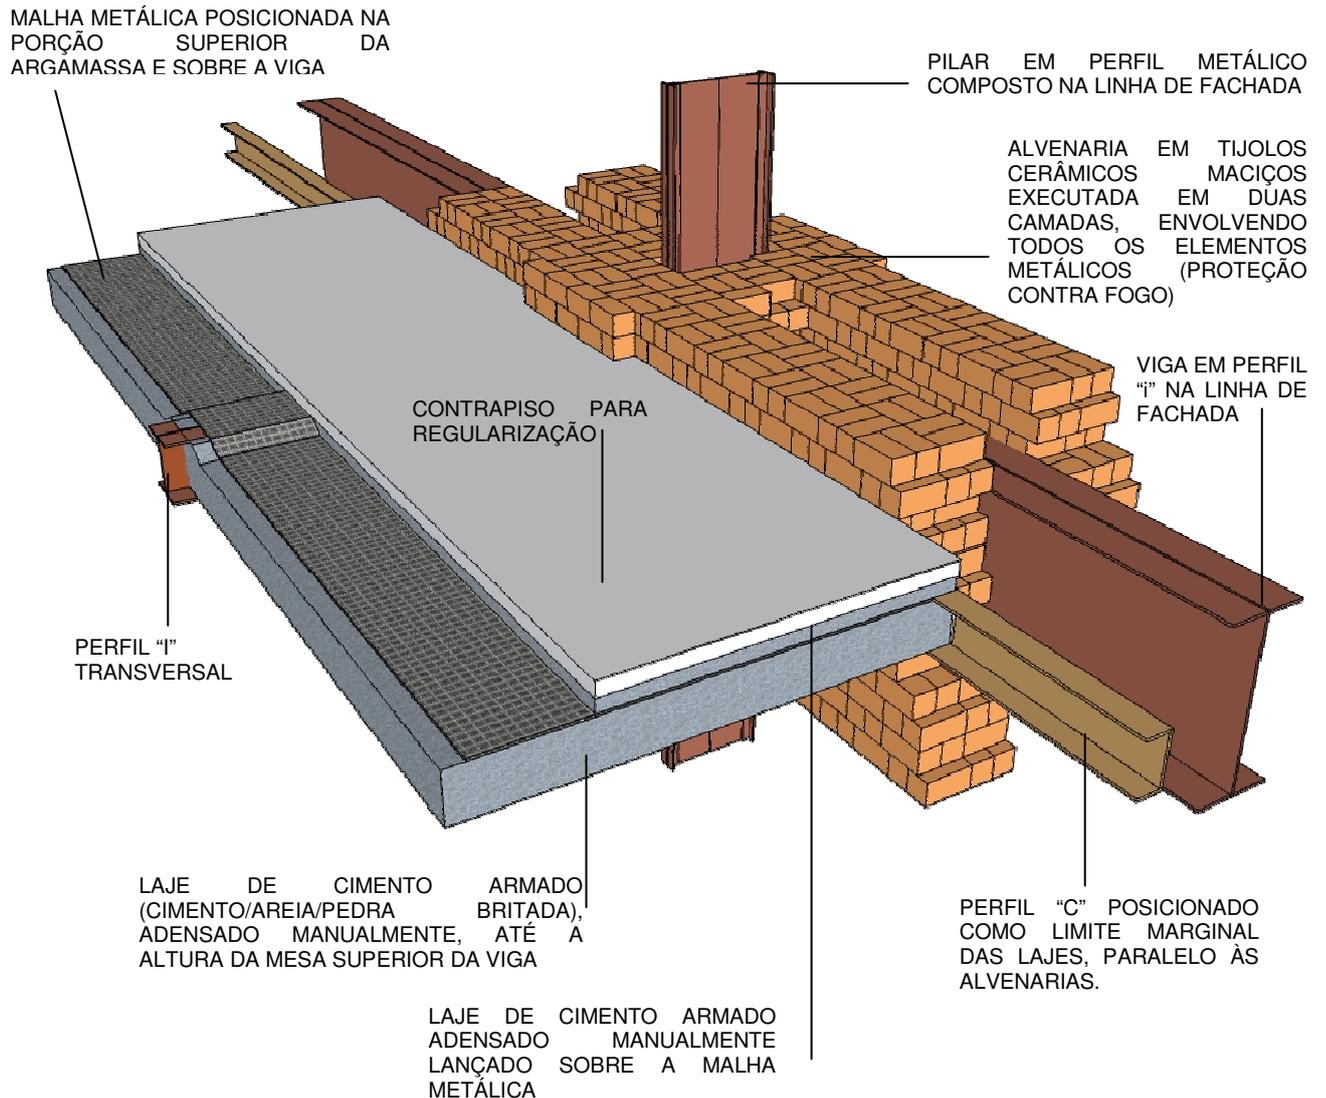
Desenho esquemático representando o sistema estrutural aplicado no prédio da Biblioteca Nacional (desenho da autora).
